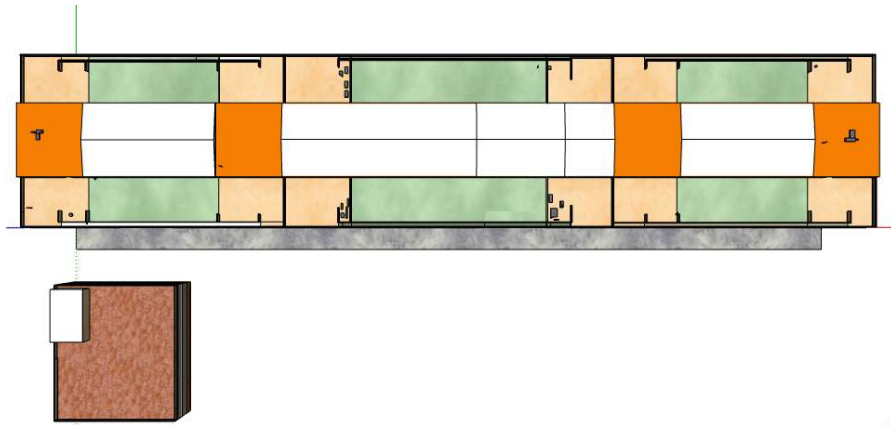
Planos de dimensiones del edificio secundario. [Realizado por el autor]
